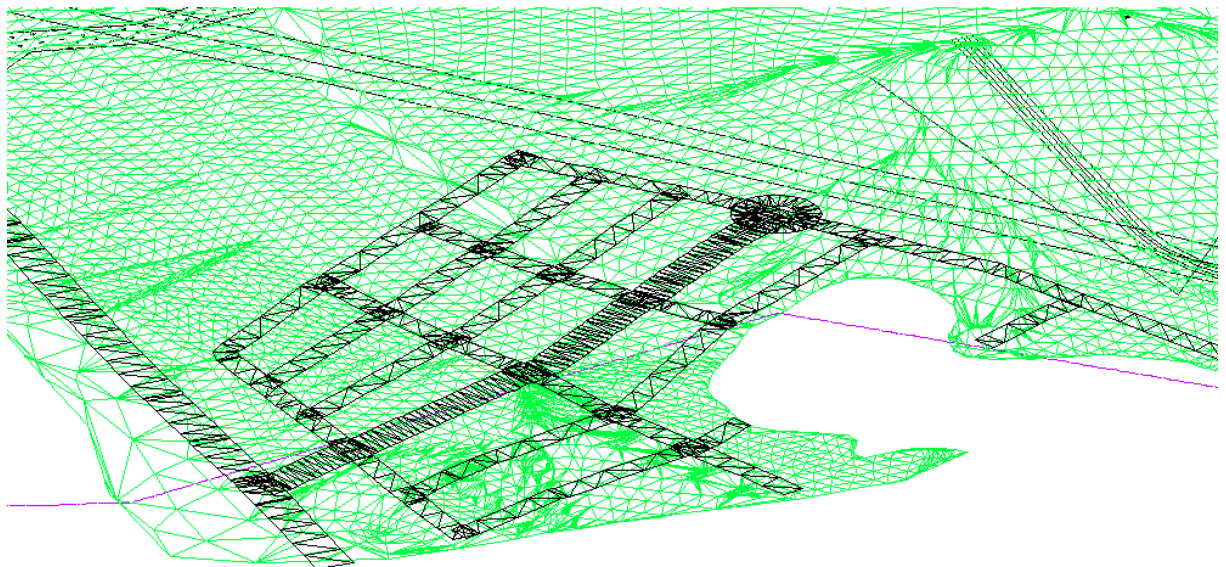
Sexta etapa do projeto geométrico (superfícies)
